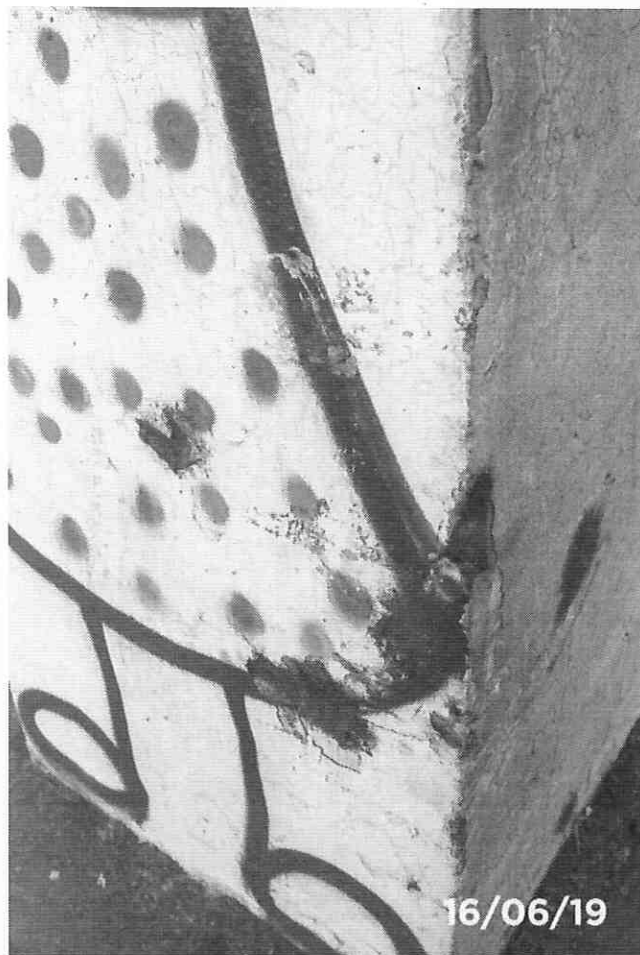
Detalhe de segregação do concreto, trincas, deslocamento do concreto do pilar, pontos aparentes de bolor, devido a infiltração de água no concreto.
